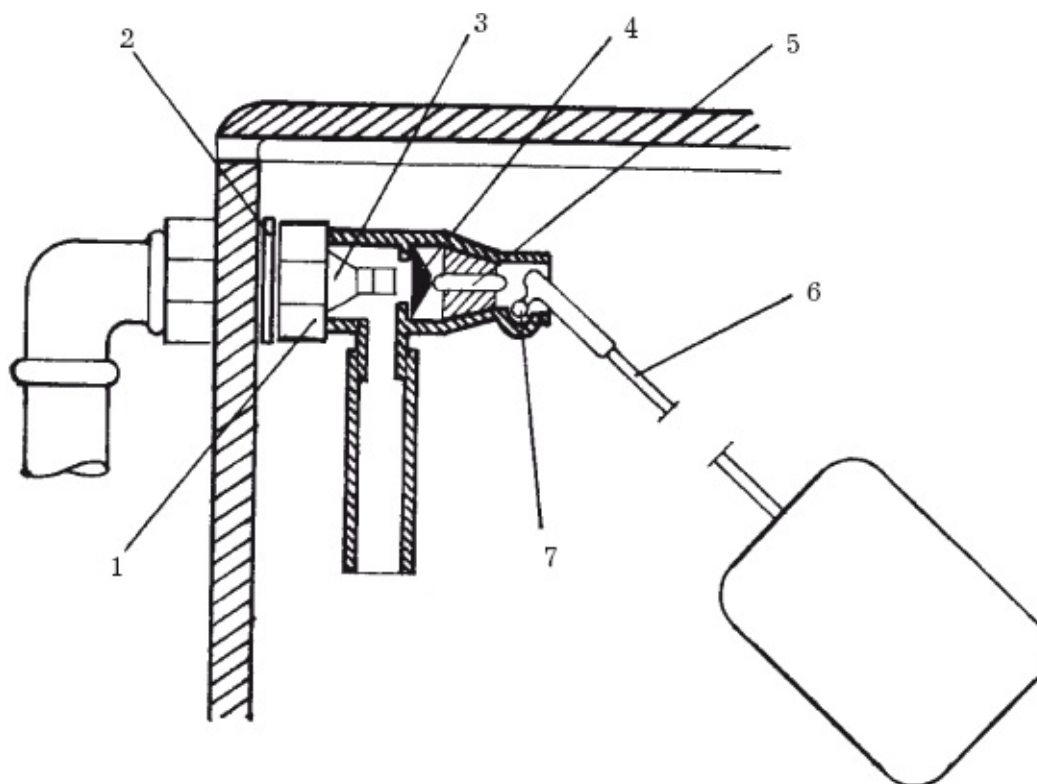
Устройство поплавкового клапана: 1 – прижимная шайба; 2 – прокладка; 3 – седло; 4 – мембрана; 5 – стержень; 6 – рычаг поплавка; 7 – ось рычага
